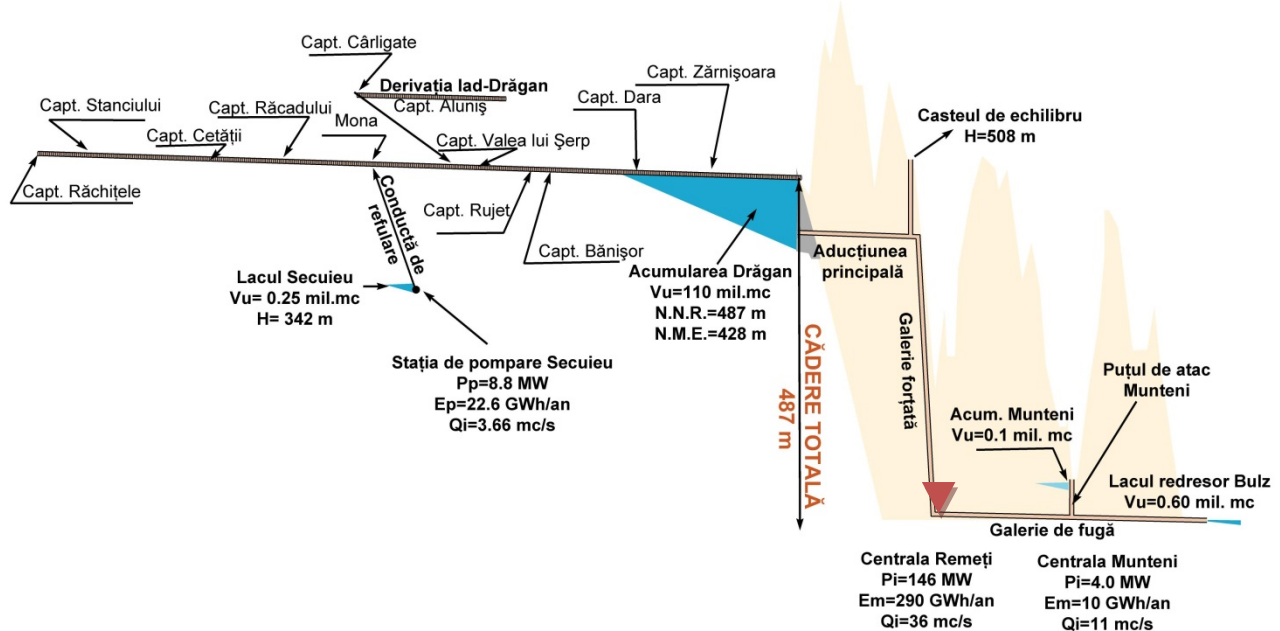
Profil longitudinal prin UHE Drăgan - Remeș (Mario Pavel, 1975)
